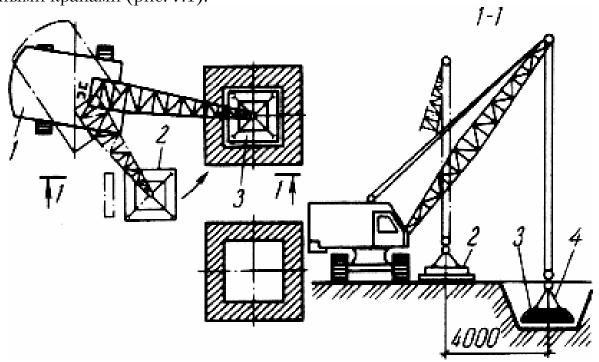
Монтаж сборных фундаментов: 1 — гусеничный кран; 2 — положение блока фундаментов до подъема; 3 — блок фундамента при установке; 4 — стропы
